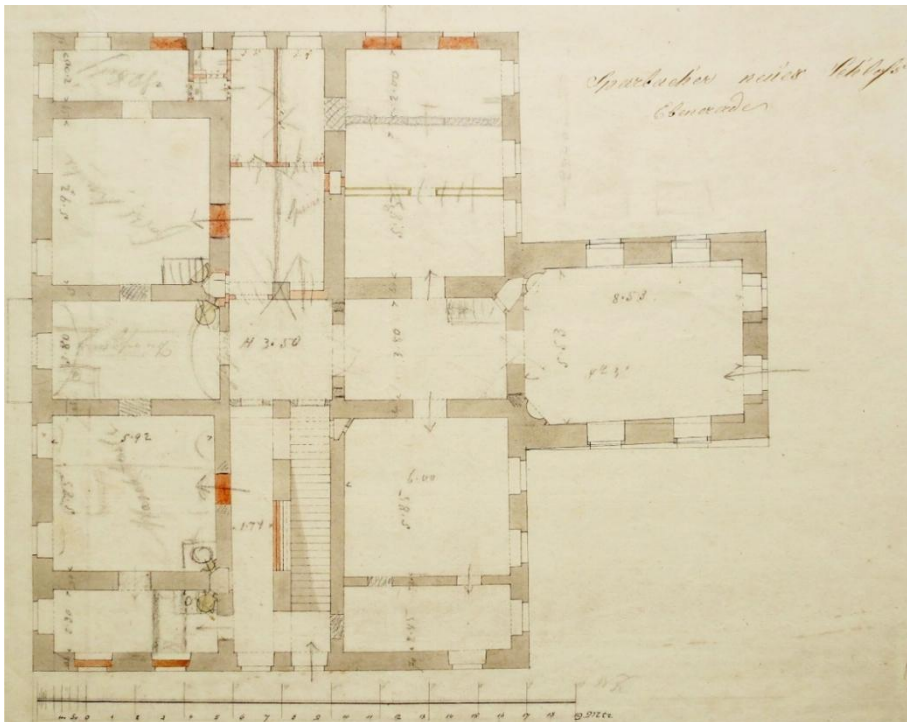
Joseph Hardtmuth, Grundriss Erdgeschoss von Neu-Schloss Sparbach, 1810.
